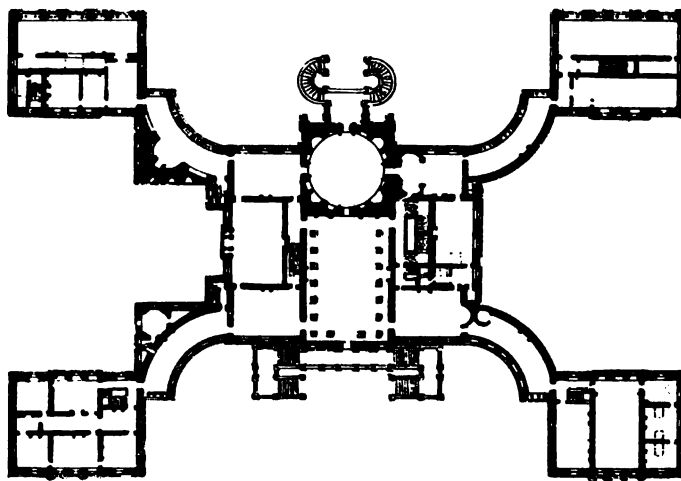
Ansicht und Grundriss von Keddlestone Hall (n. Fergusson).
